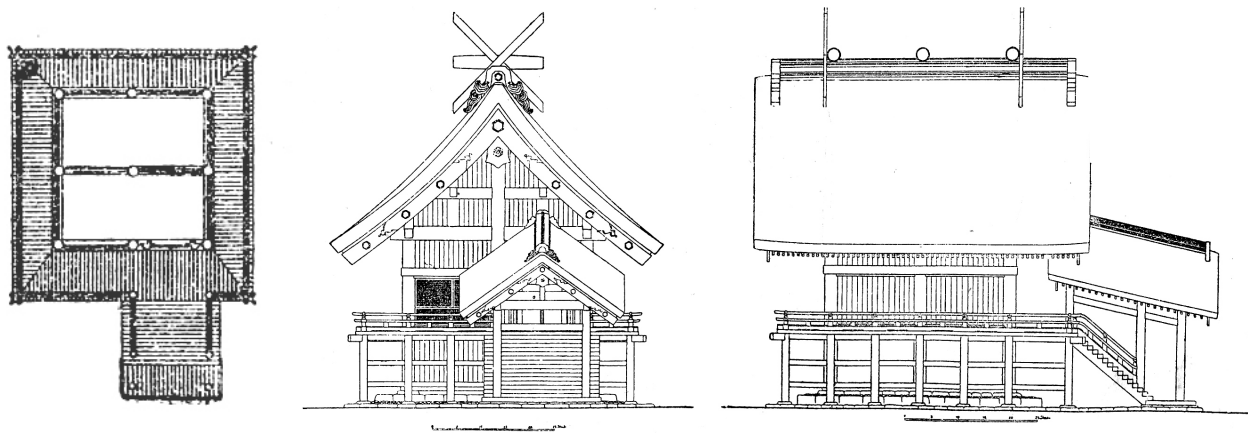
De izquierda a derecha: planta, alzado frontal y alzado lateral de un honden de estilo taisha.
